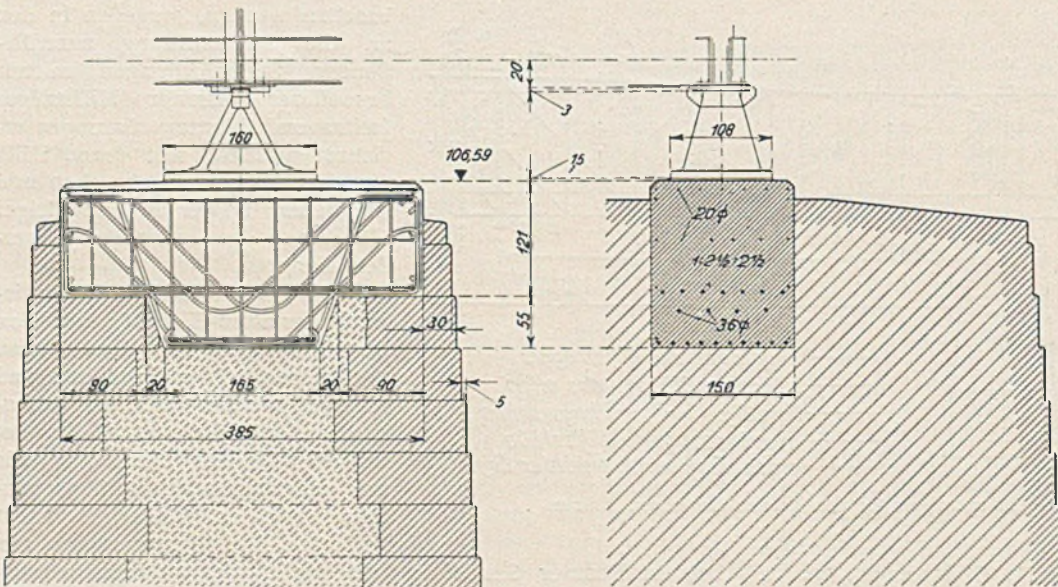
und 44. Quer- und Längsschnitt der Strompfeiler D und E mit den neuen Eisenbeton-Auflagerquadern.
